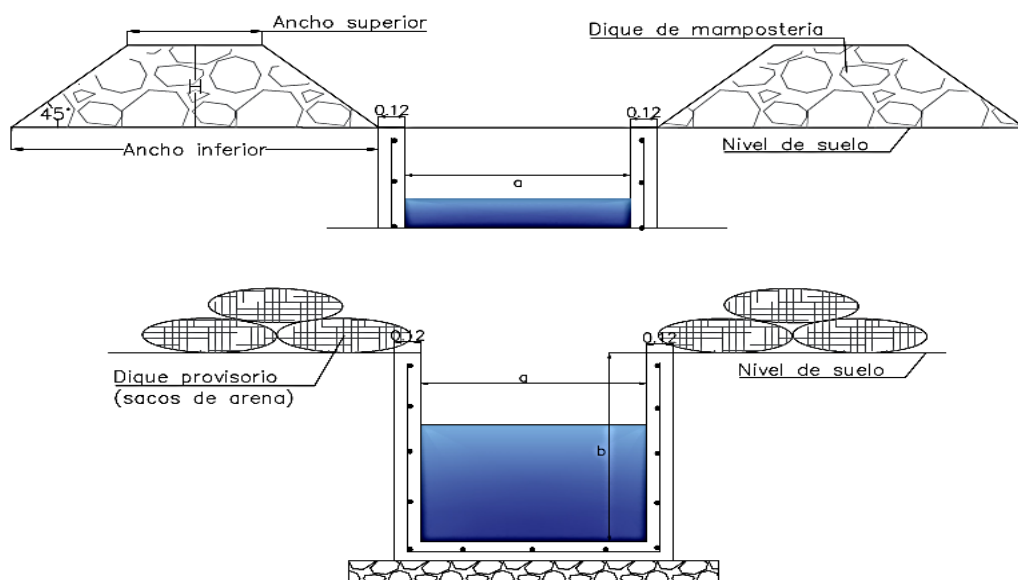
Sección tipo de dique de mampostería hidráulica y dique provisorio para un canal de riego (cotas en m). Fuente: elaboración propia.
